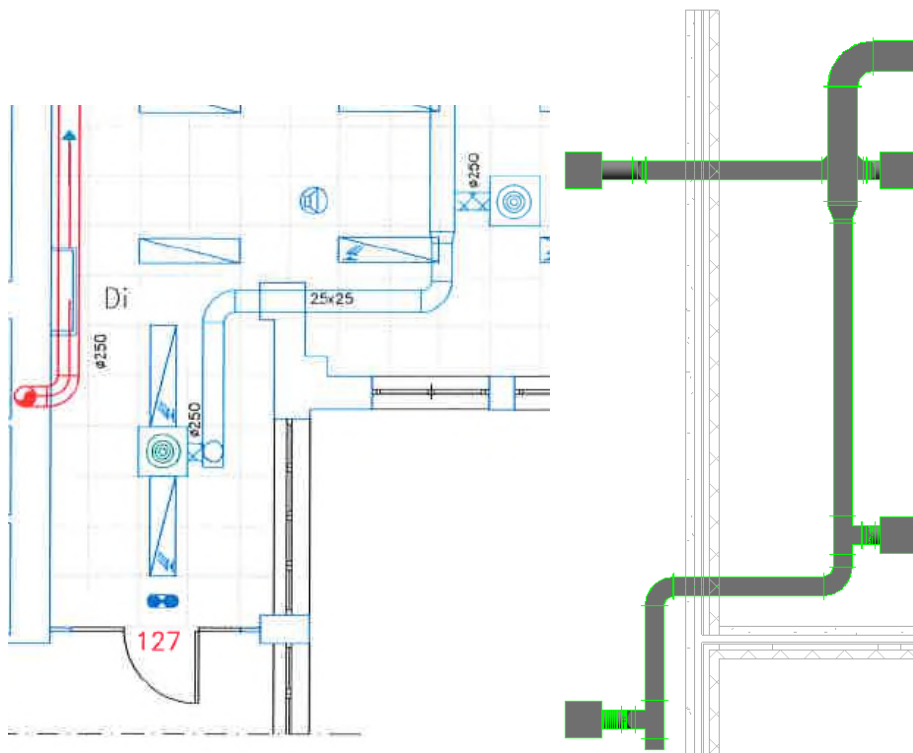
Izda: planta según plano. Dcha: modelo Revit
